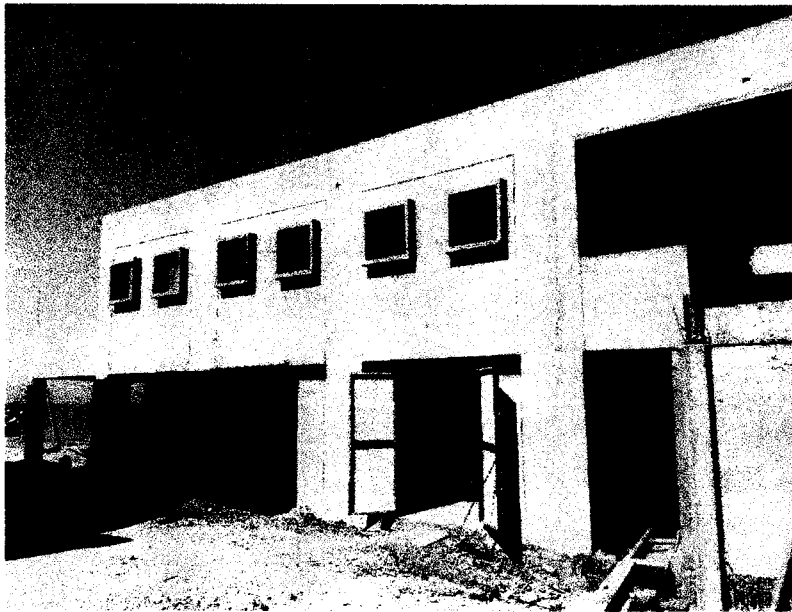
Tarrajeo de muros exteriores, vigas y columnas.
